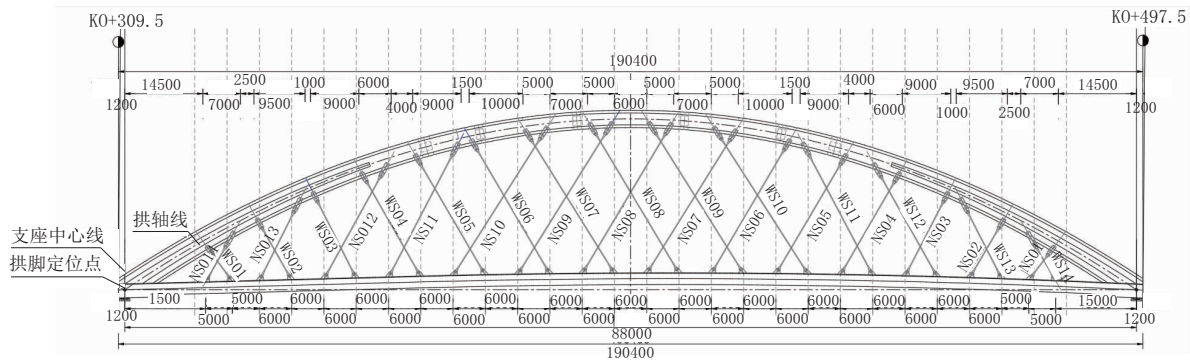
空间网状钢箱系杆拱桥立面图(单位:mm)
